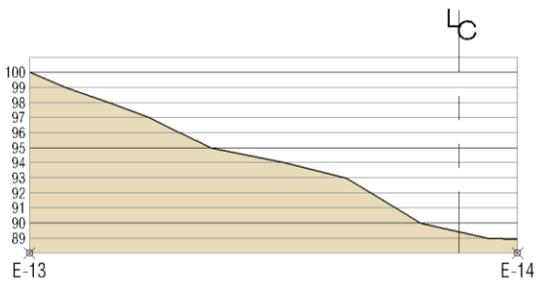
Acceso al sitio. Fuente: Elaboración propia.
